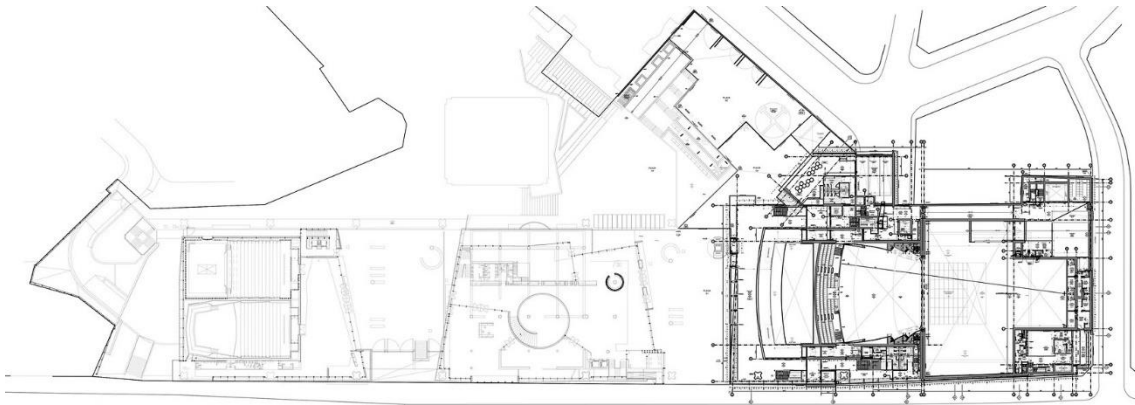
Planta arquitectónica del primer nivel, etapa 2.
